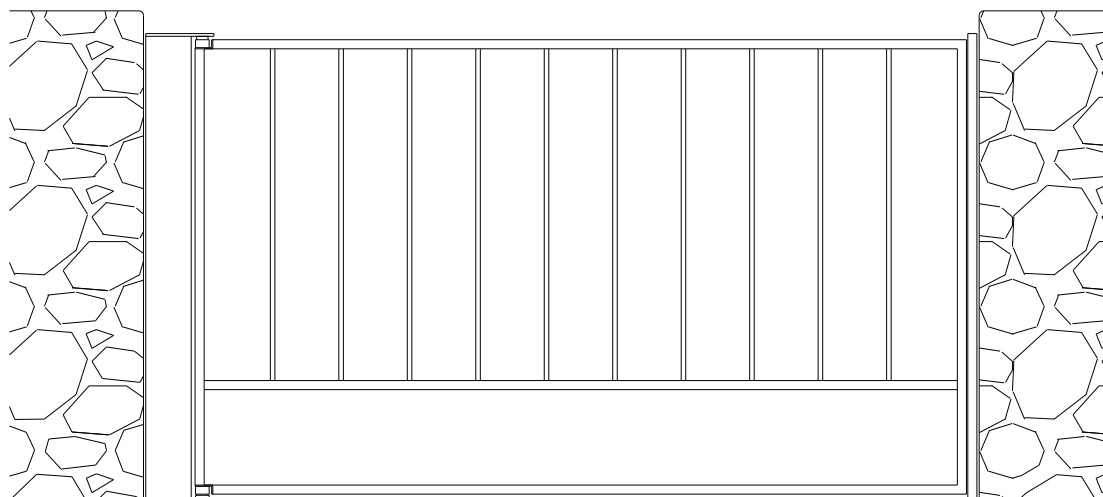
Detalle de alzado de puerta industrial batiente cancela de 1 hoja.
